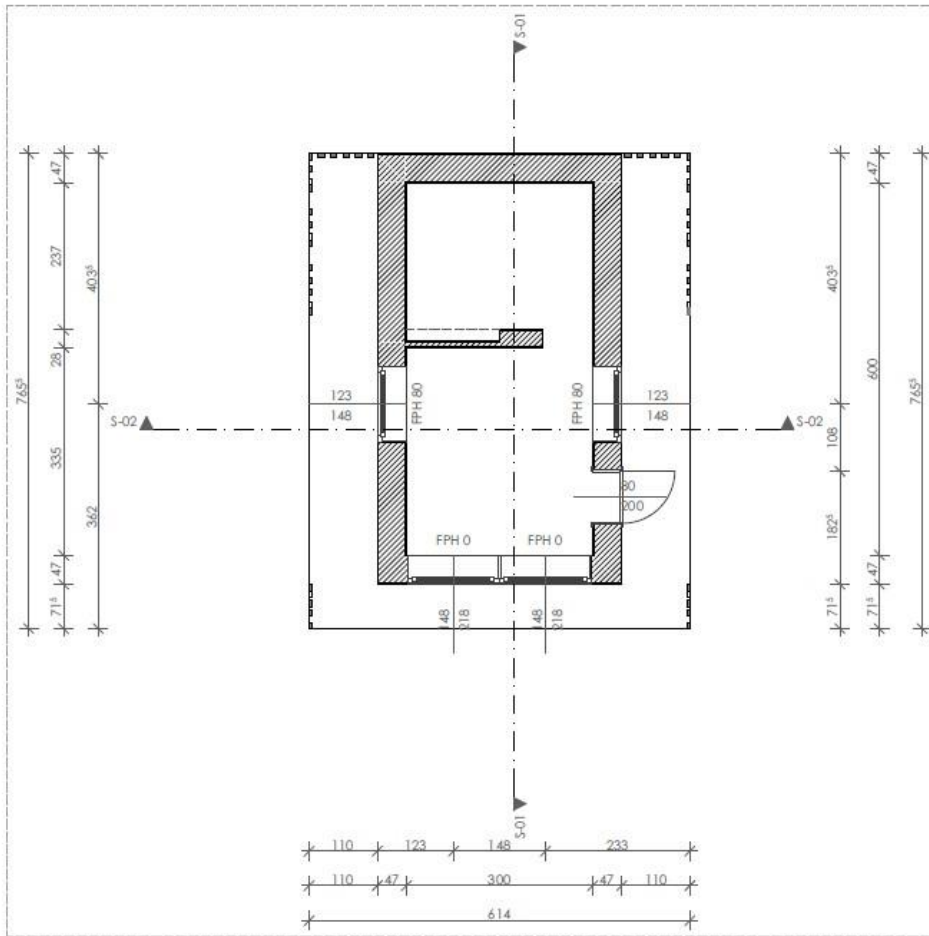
Baukonstruktiver Grundriss, M 1:100
